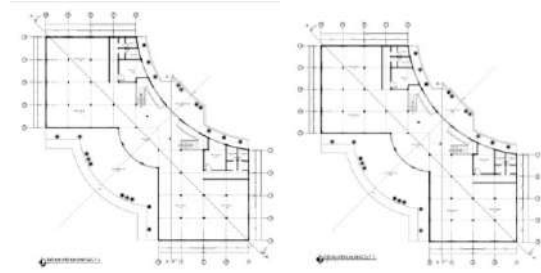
Denah Gedung Pelatihan LT 1& 2
